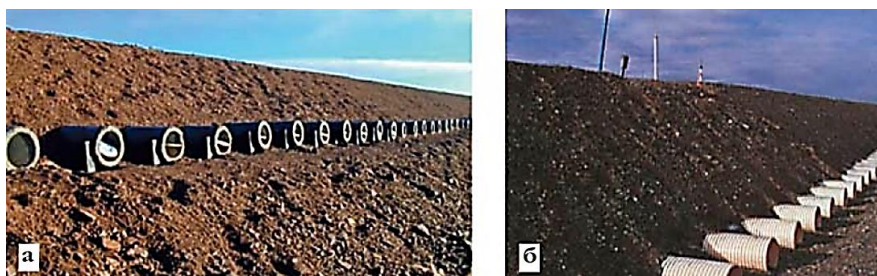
Поперечные вентилируемые трубы в откосах насыпи:
